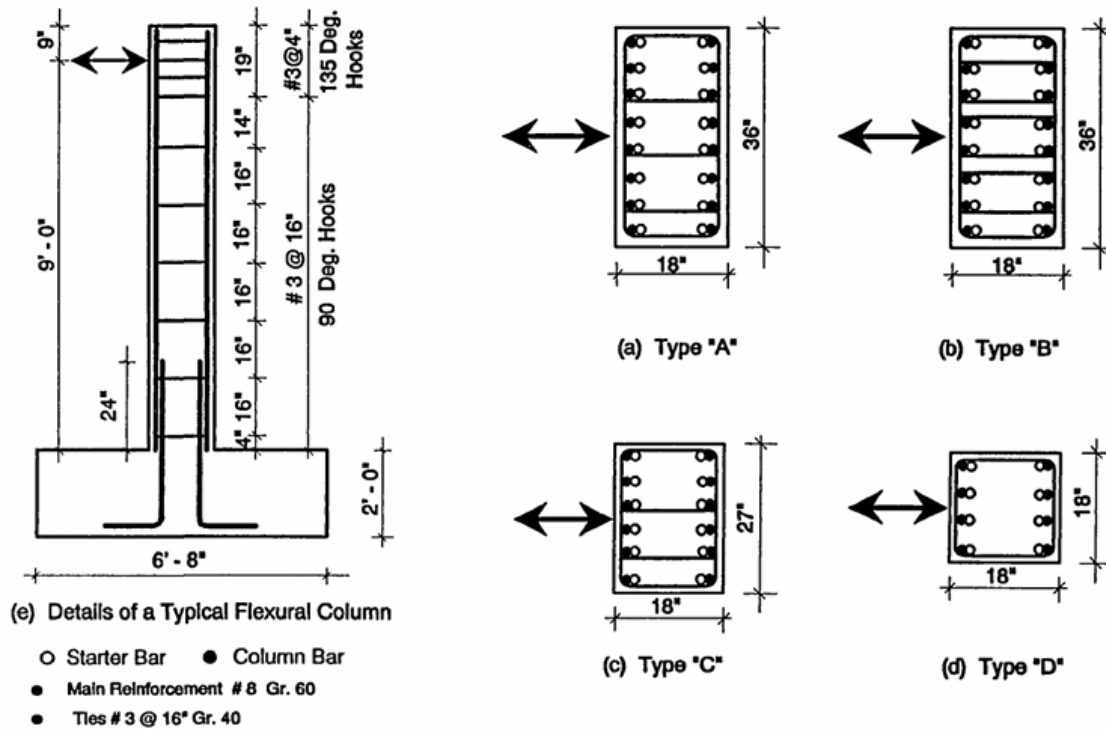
Sección transversal y armado de los tipos de columnas de la fase I (1 pie = 0.30 m, 1 pulg = 2.54 cm) (Aboutaha, 1994).
